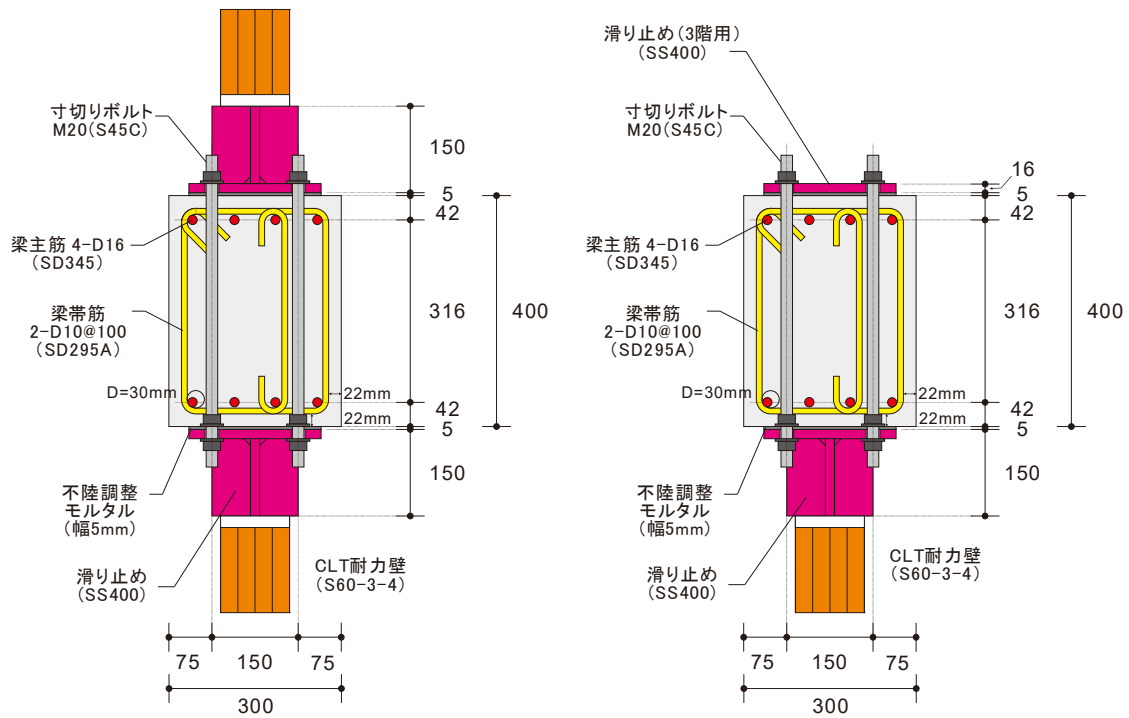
試験体 WA の CLT 耐力壁取り付け後のはりの断面図
